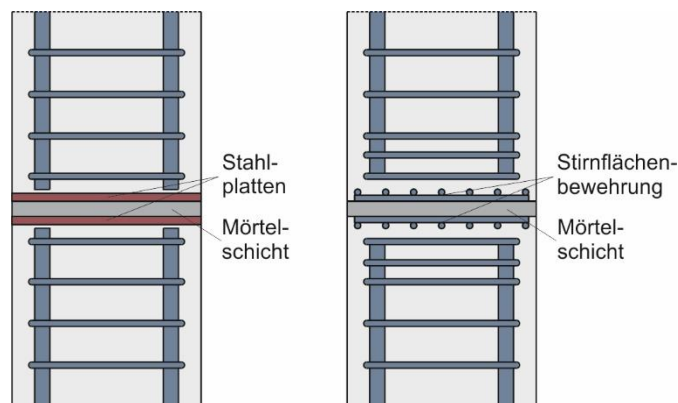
Ausführungsvarianten von Stumpfstößen: mit Stahlplatten (links) und mit Stirnflächenbewehrung (rechts)
